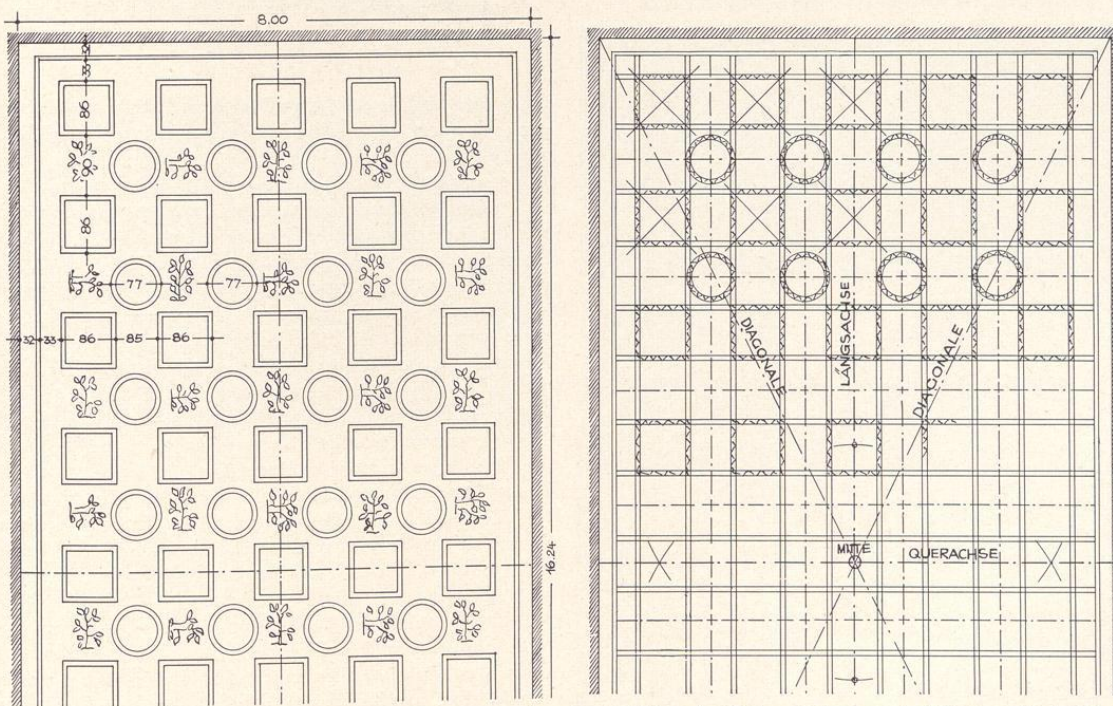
Stuckdecke von Bild 487, links im Grundriß, rechts der Aufriß an der Decke mit den zur Ausführung erforderlichen Hilfslinien
